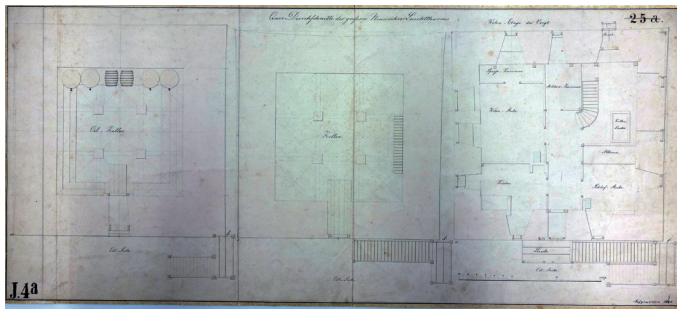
Plansatz zum Aufmaß von 1845 (NLA ST, Mapped 0446) mit Grundrissen zu allen Hauptebenen, einem Querschnitt (Blick nach Nord) und der Ostfassade.
